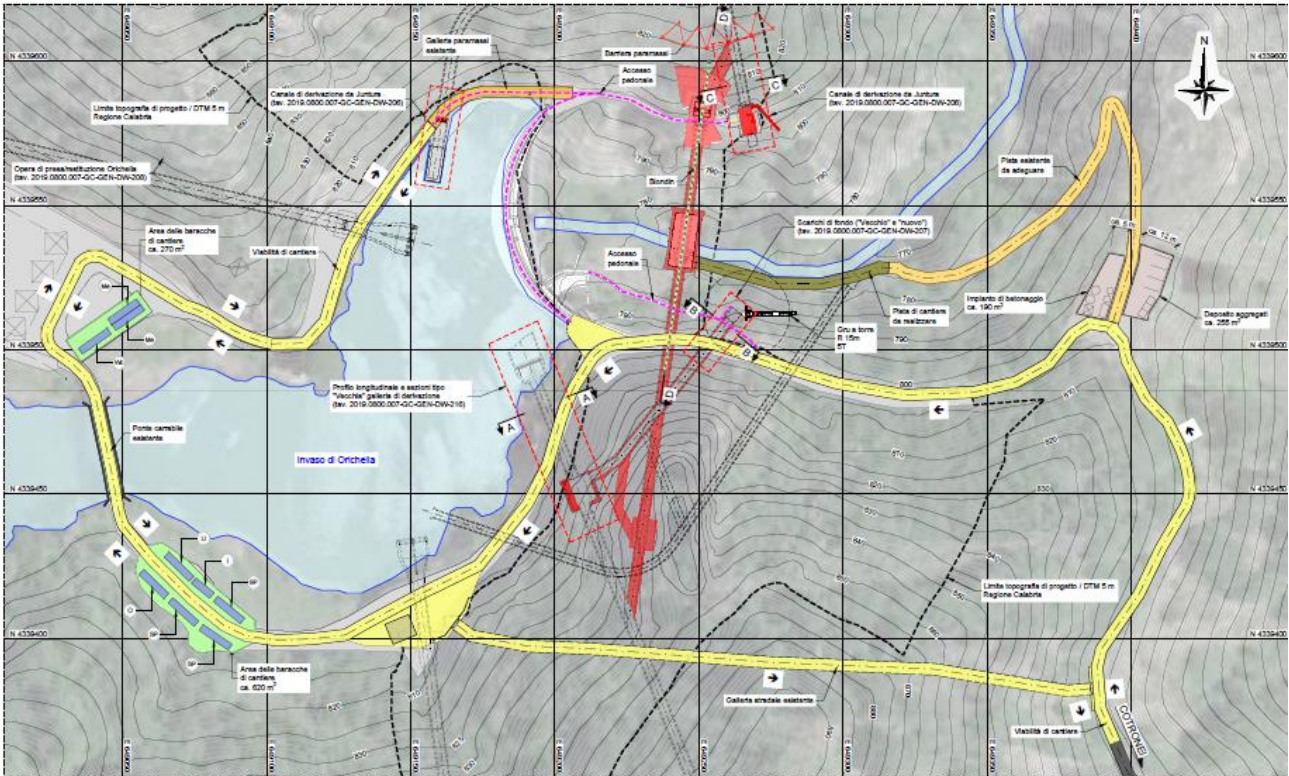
planimetria delle aree di cantiere nell'area di Orichella
